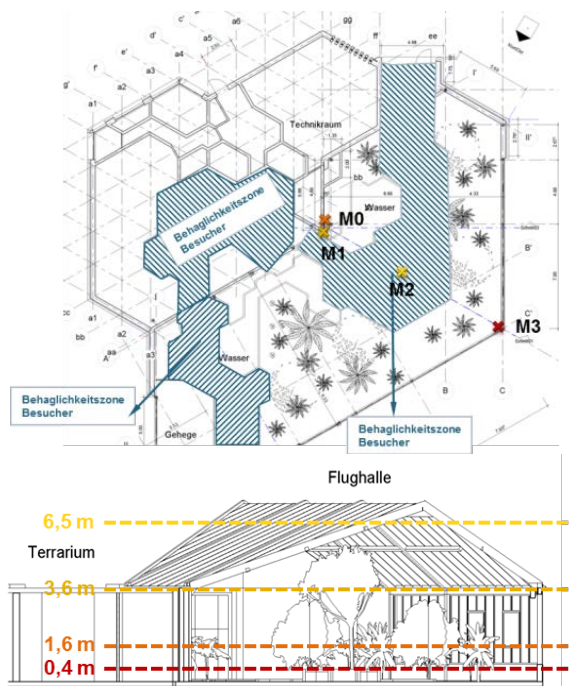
Grundriss- und Höhenprofilardarstellung zur Temperaturmessung
